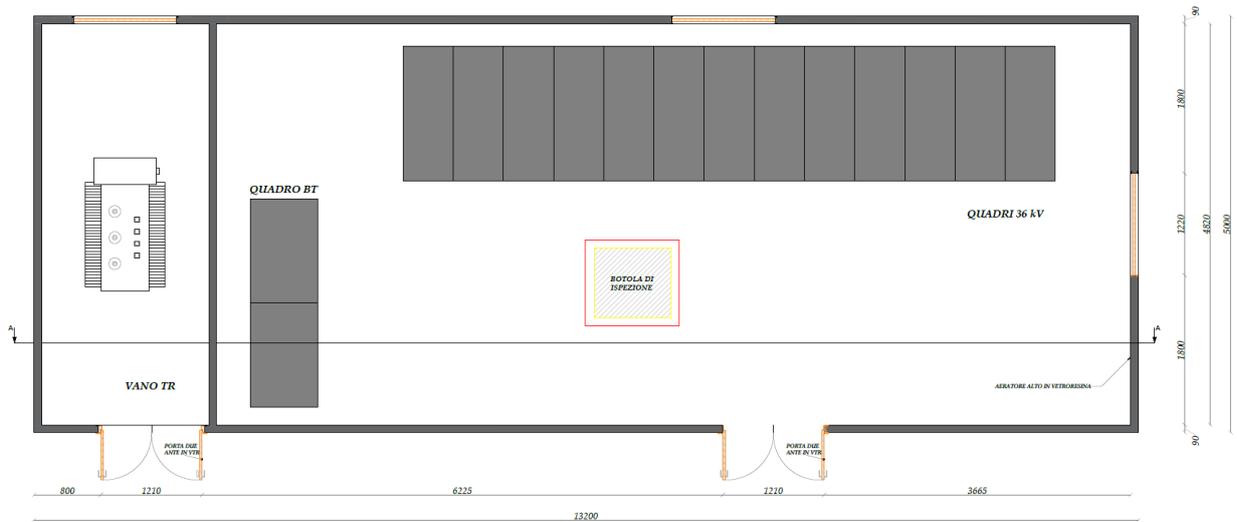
Pianta della cabina di raccolta CR2 36 kV.
